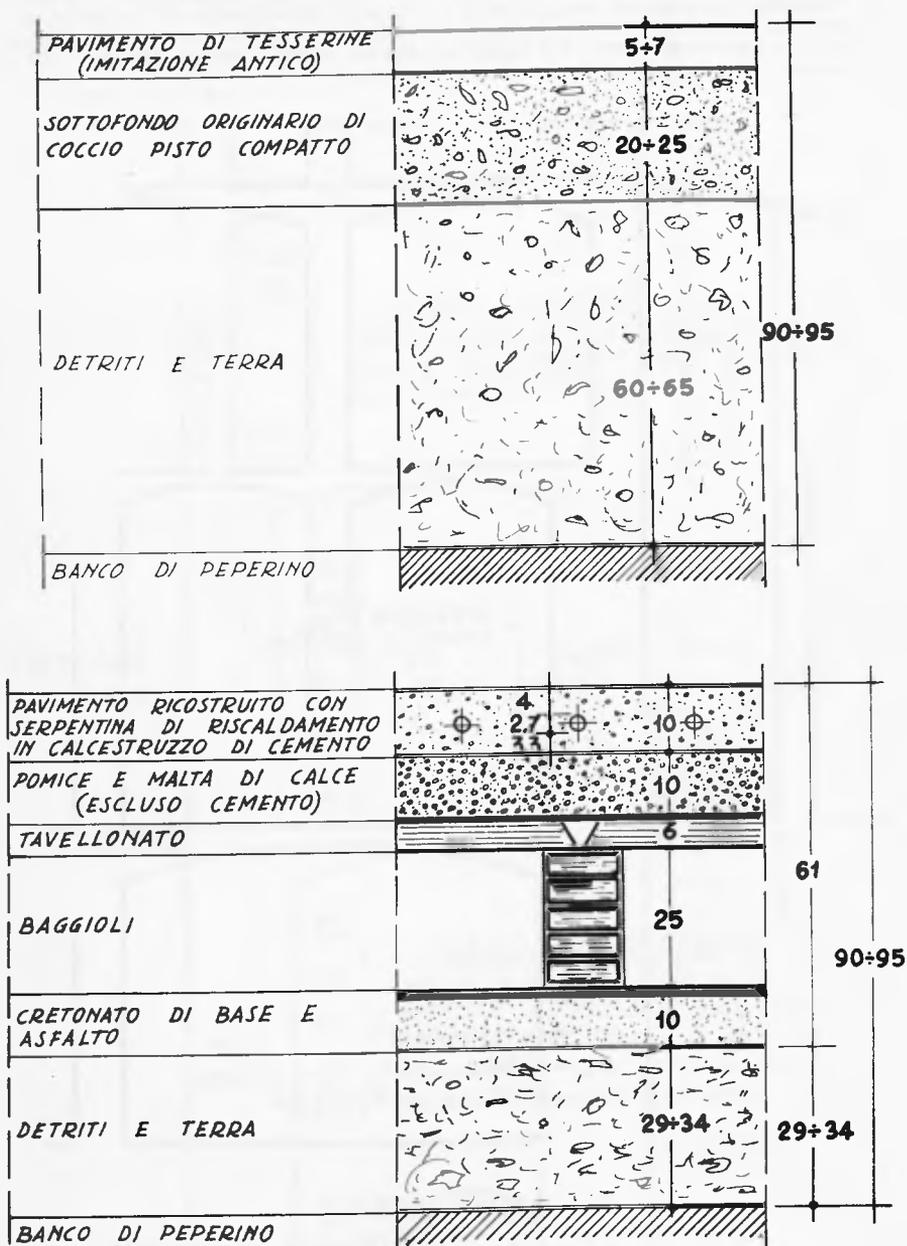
Un perfetto risanamento è stato ottenuto asportando il vecchio e massiccio pavimento termale (la cui sezione è nella figura superiore) e costruendo un nuovo pavimento a camera d'aria e pomice leggermente radiante, come alla sezione della figura inferiore.
